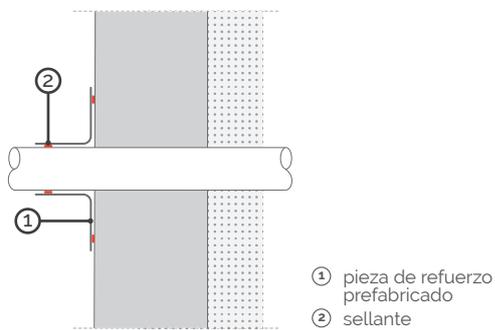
Encuentro del cerramiento con un elemento pasante horizontal resuelto con una pieza de refuerzo prefabricada
